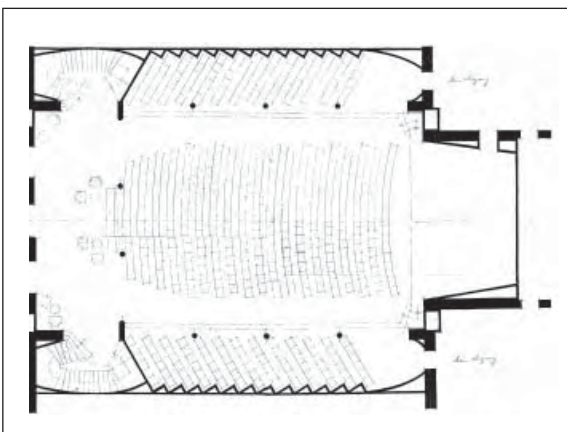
Laeiszhalle, Kleiner Saal, Grundriss, Umbauentwurf von B. Mundt vom November 1952
